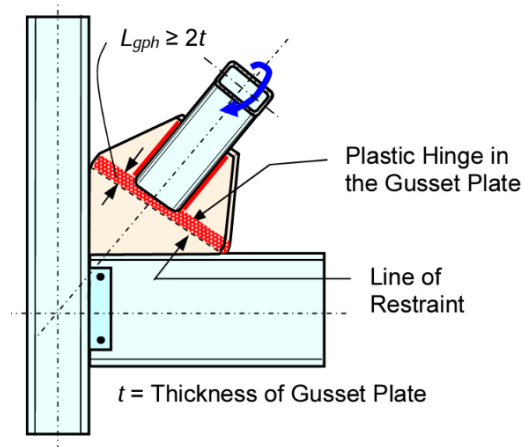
Punto de generación de rótula plástica en plancha gusset cuando se genera el pandeo del arriostramiento en la dirección fuera del plano. (Fuente: Astenah-Als et al. , 2016).
